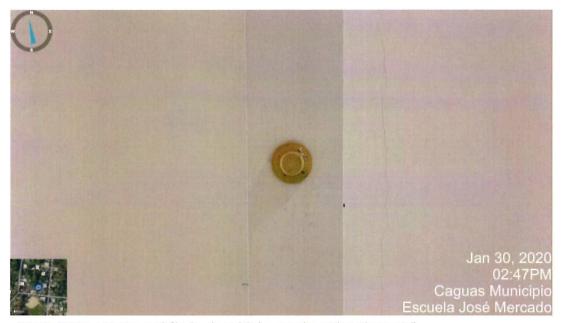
Grietas existentes en plafón de salones (Kínder, comedor, y educación especial)
